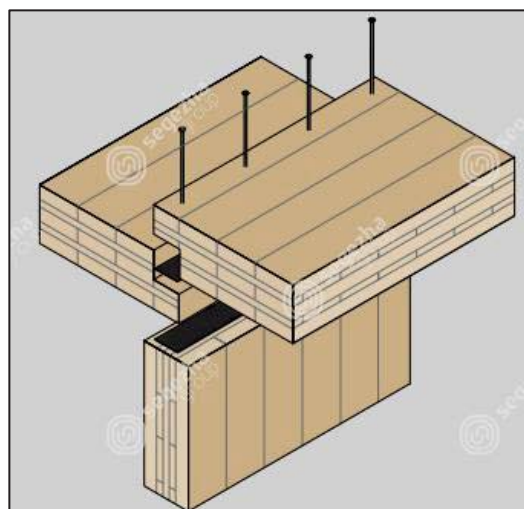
Узел сопряжения плит перекрытия вполдерева с опиранием на стену
